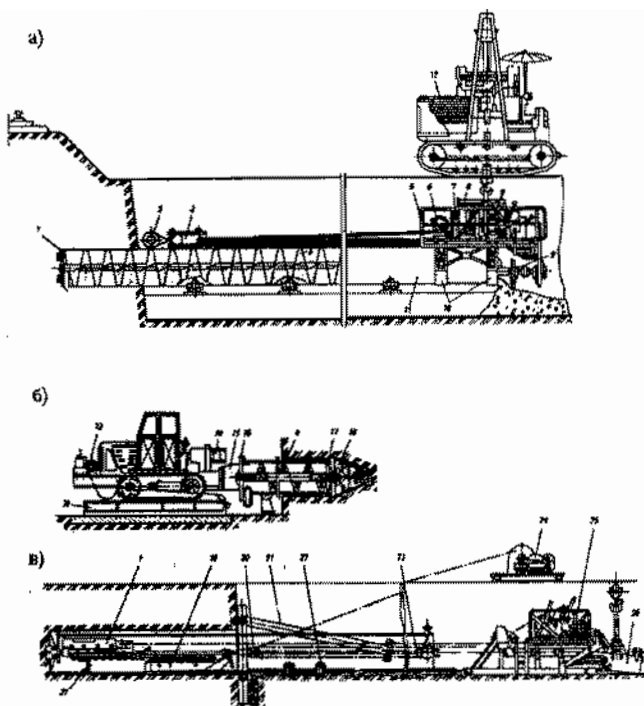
Бестраншейная прокладка труб способом горизонтального бурения установками типа УГБ и ГБ (а), УГБ на тракторе (б) и ПМ-800-1400 (в): 1 - режущая головка; 2 - упорный якорь; 3 - полиспаст; 4 - шнек; 5 - рама; 6 - лебедка; 7 - карданный вал; 8 - двигатель внутреннего сгорания; 9 - вал привода шнека; 10 - хомуты; 11 - прокладываемая труба; 12 - кран-трубоукладчик; 13 - тяговое устройство на тракторе; 14 - сварочный генератор; 15 - коробка отбора мощности; 16 - опорная плита; 17 - люнет; 18 - рабочий орган; 19 - совок; 20 - обойма блока; 21 - опорная стенка; 22 - направляющая рама; 23 - захват; 24 - лебедка подачи; 25 - разгрузочно-тяговое устройство; 26 - емкость; 27 - разгрузочный обратный клапан
